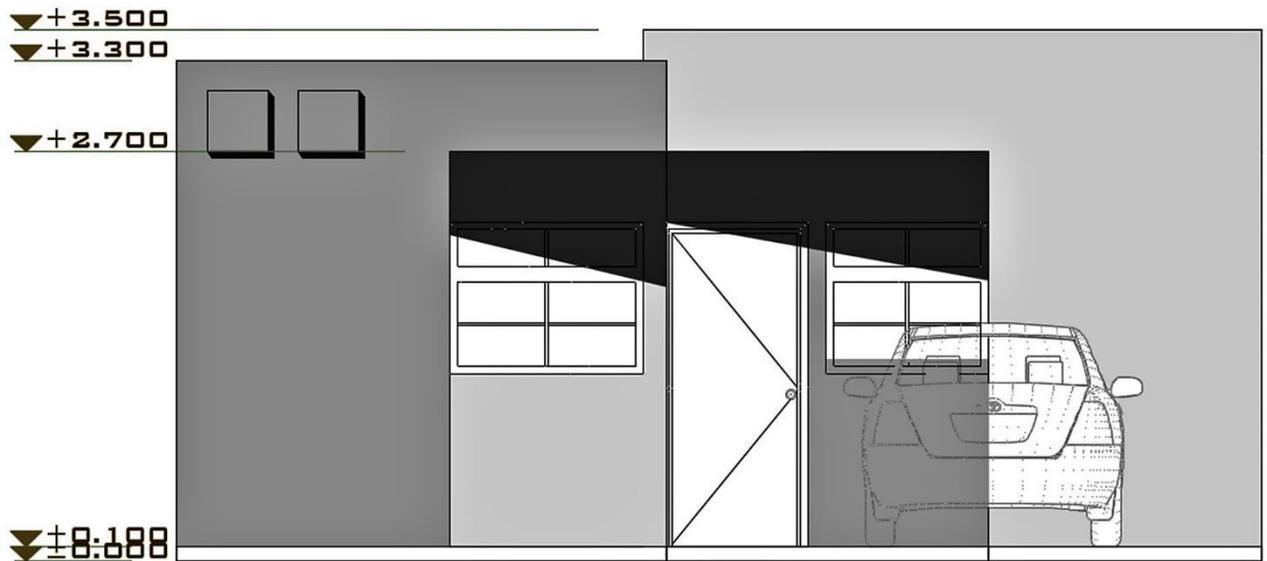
Presenta una vista general de la fachada frontal de la vivienda.
